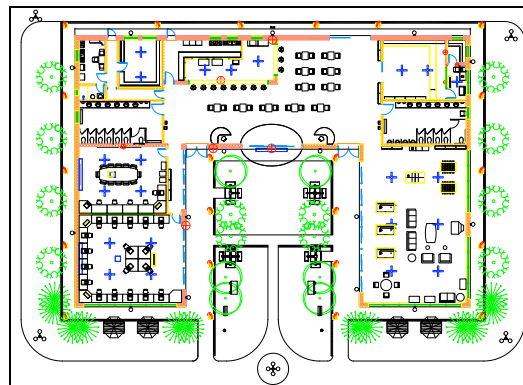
Planta do pavimento térreo do Projeto “C” (s/esc.).
